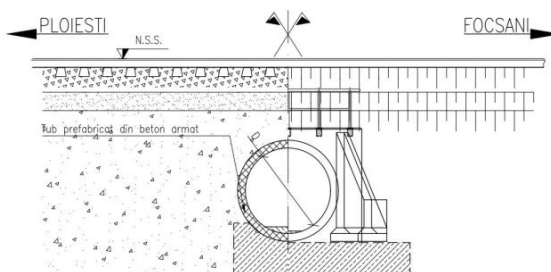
Exemplu de podeț realizat din tuburi prefabricate din beton armat
